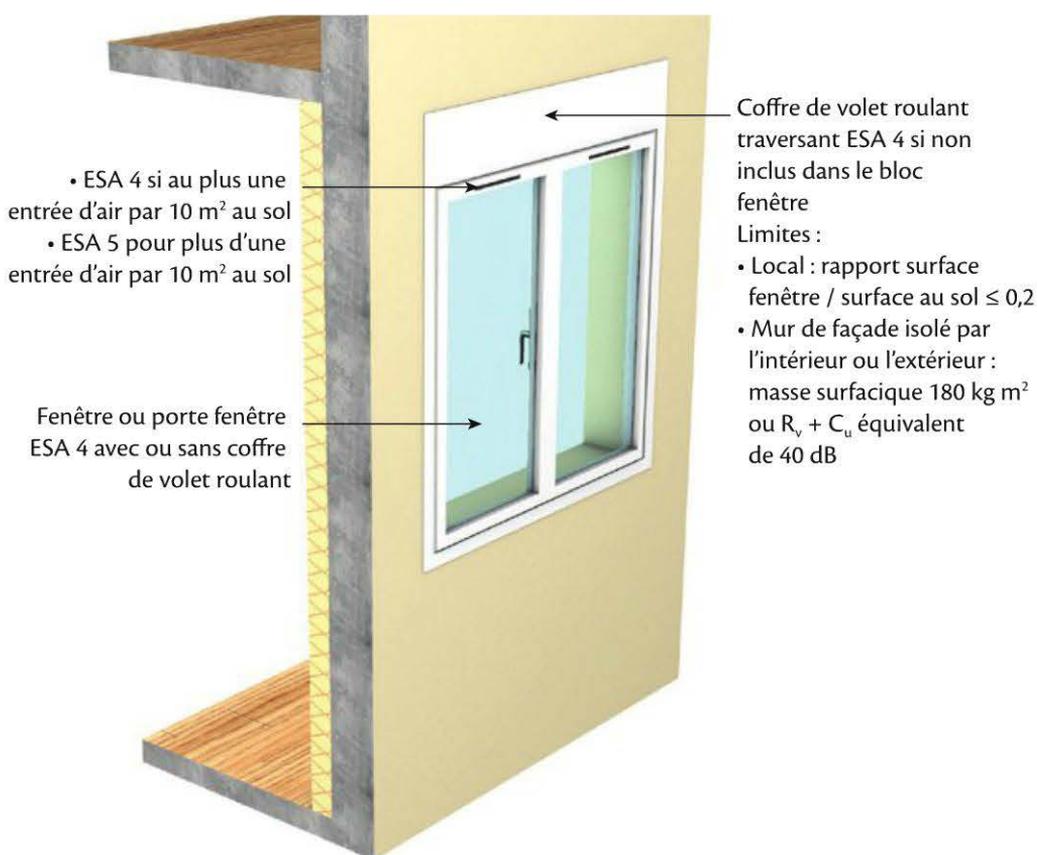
Exigences sur les entrées d'air pour un isolement de façade de 30 dB
